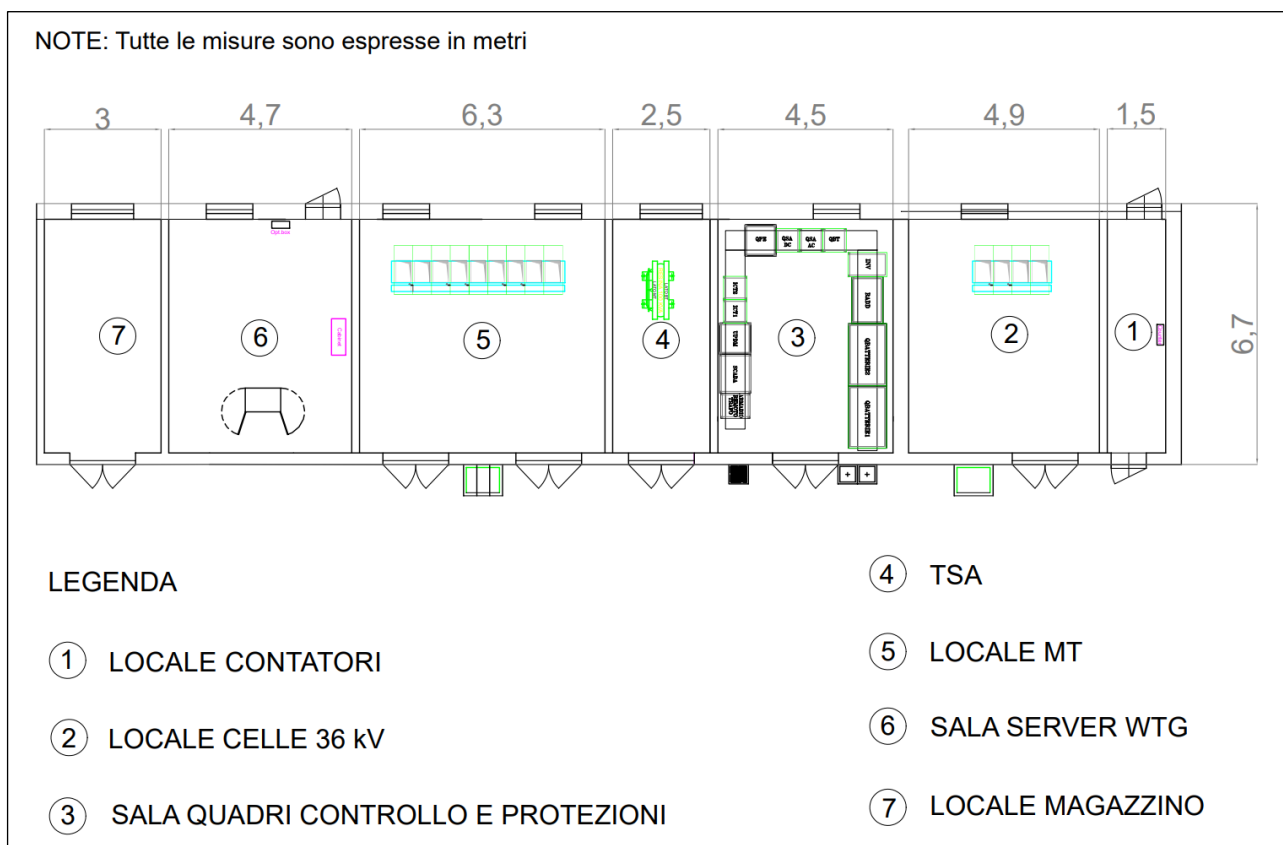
Pianta edificio di controllo SEU 36/33 kV
